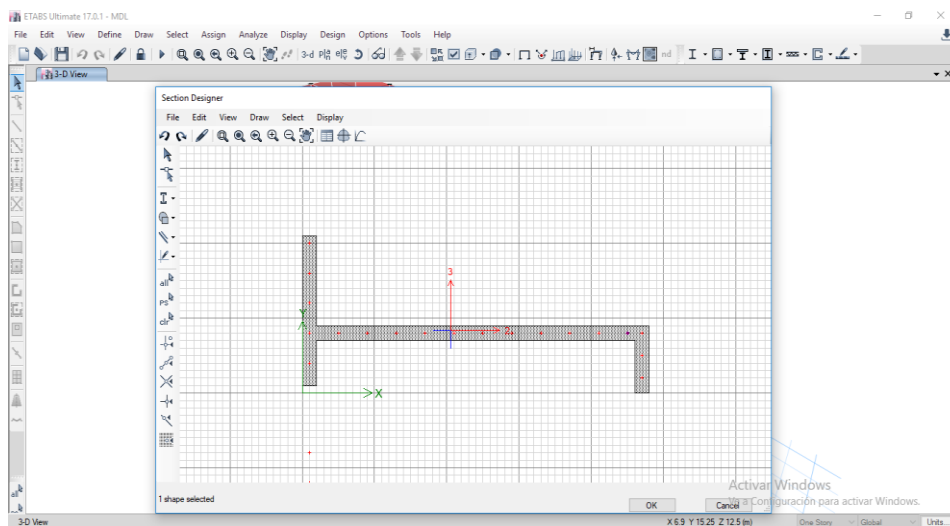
vista de distribución del acero de refuerzo en el muro “baño”
